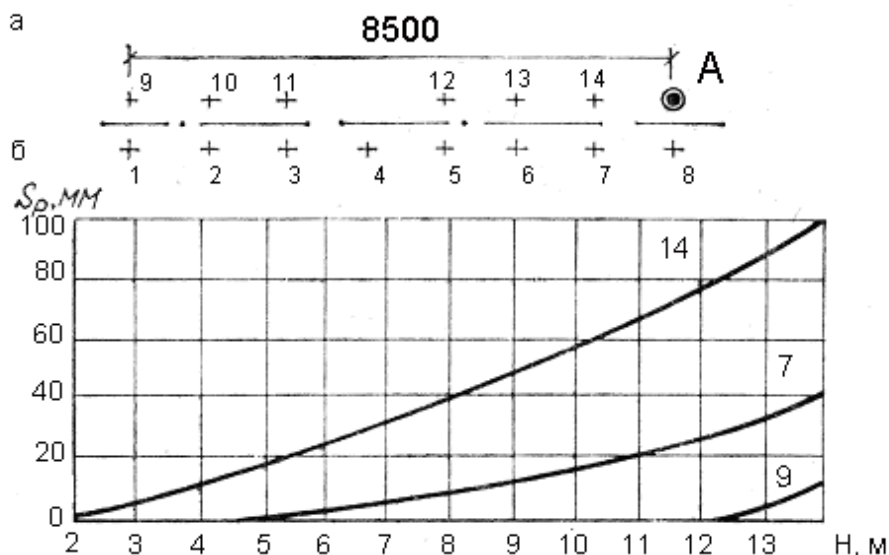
Подъем ранее забитых свай при погружении последующих: а – план размещения свай; б – подъем свай; А – погружаемая свая; 1-14 - номера свай
